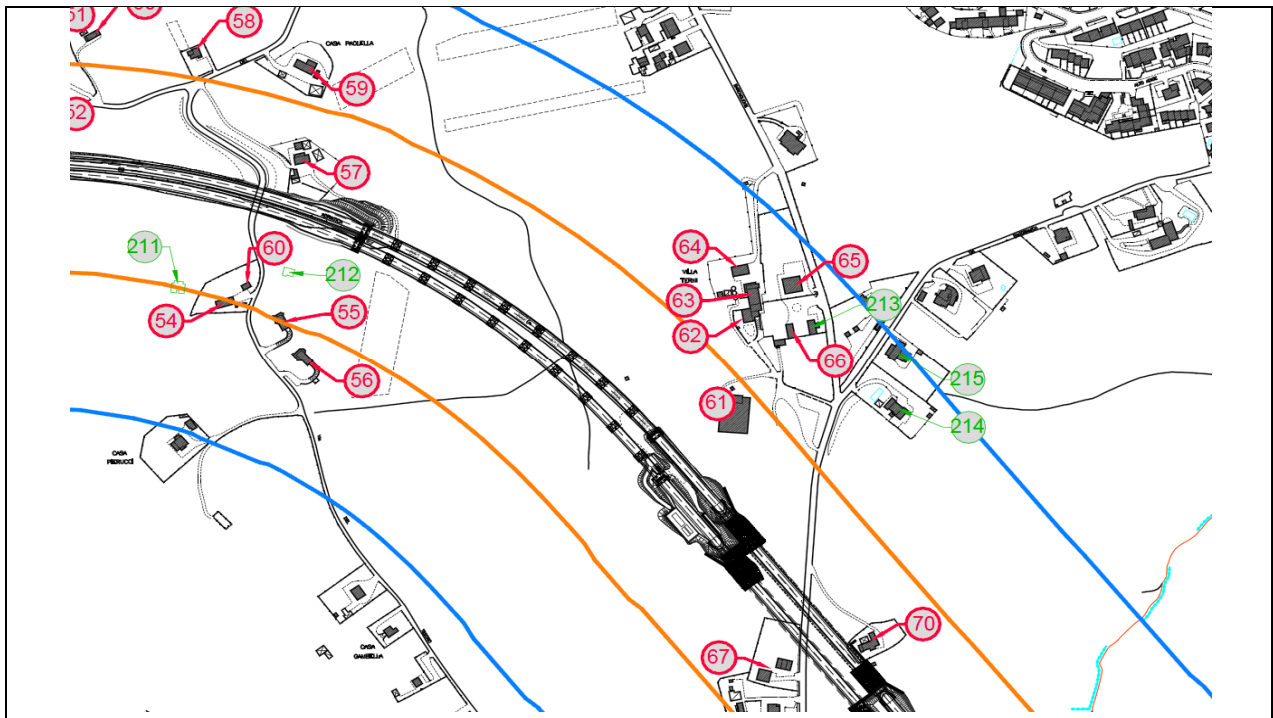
Estratto della planimetria di localizzazione, dei ricettori censiti e della zonizzazione acustica - Tav. 2 - Viadotto Falconara
